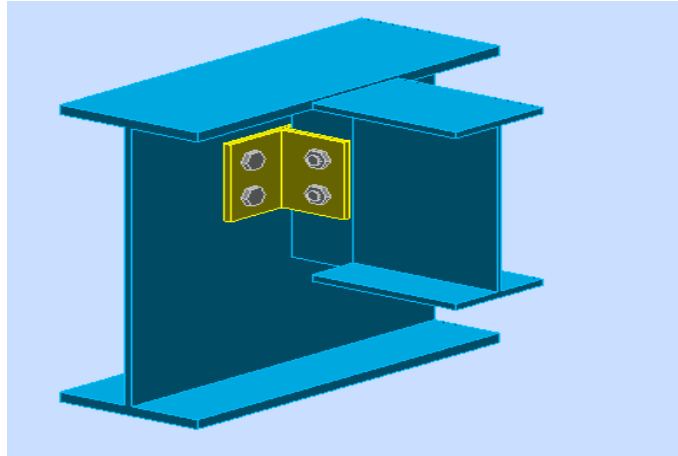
Vue de l'assemblage poutre maitresse-solive
